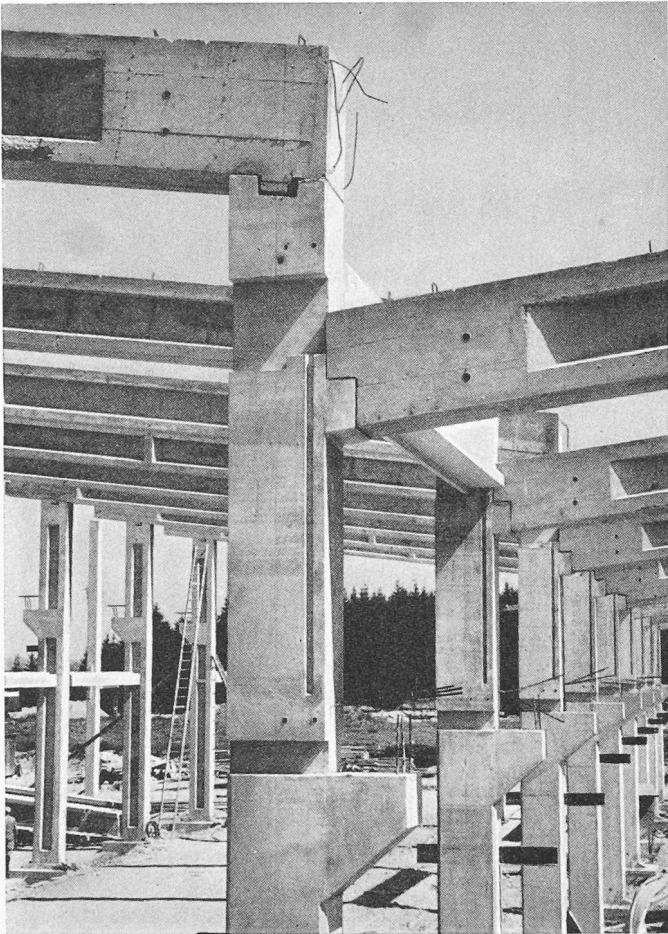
Details einer vorfabrizierten Halle der Stuaug in Zollikofen BE
